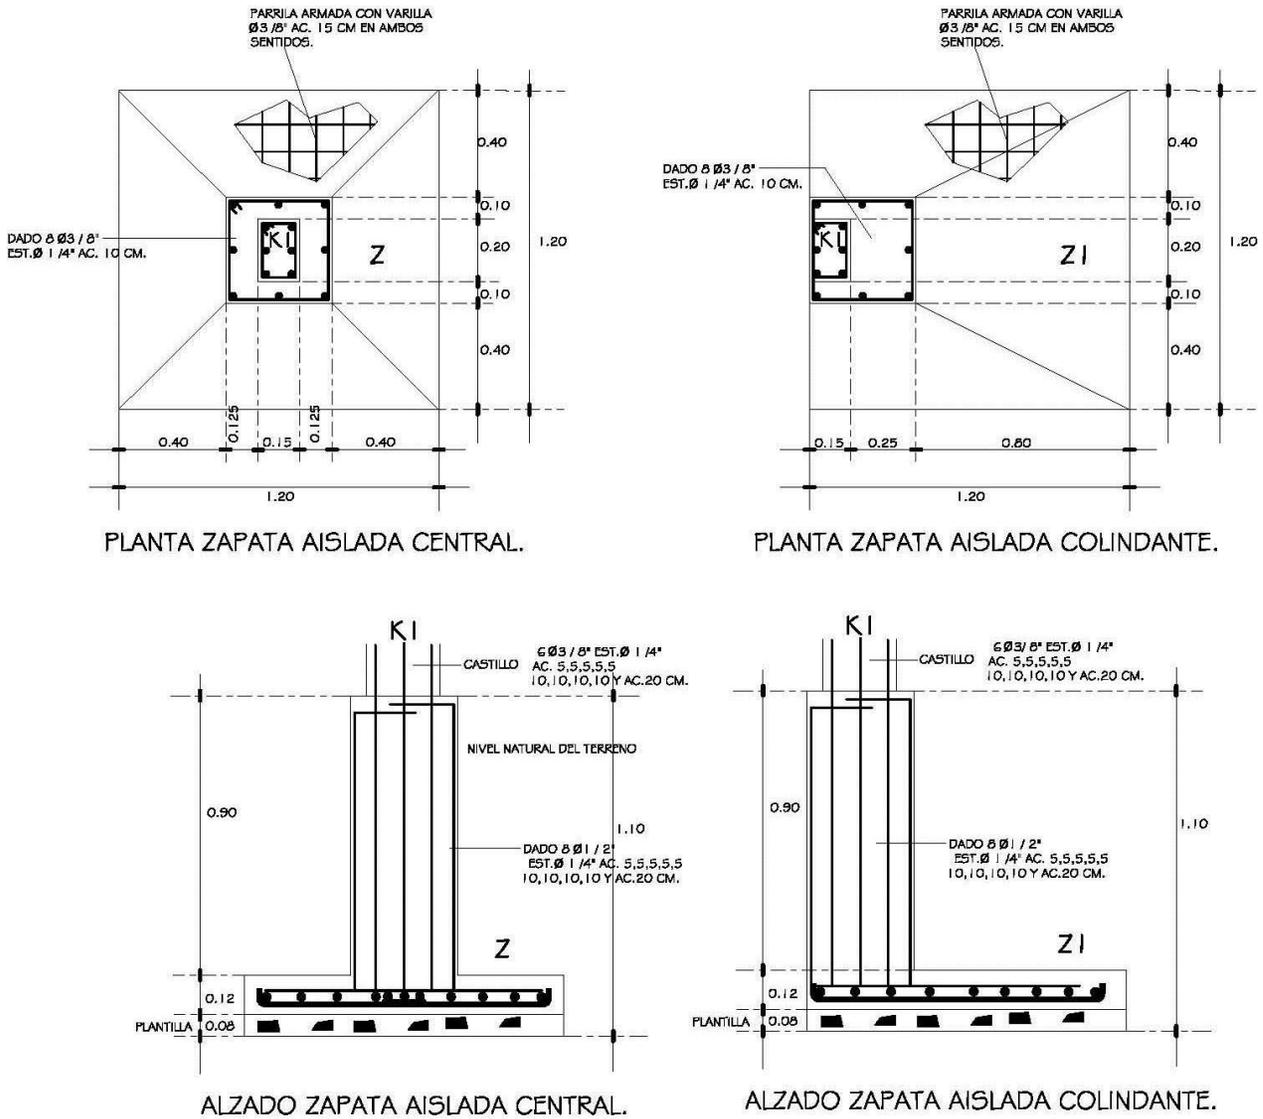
Detalles de la cimentación de zapatas aisladas.
